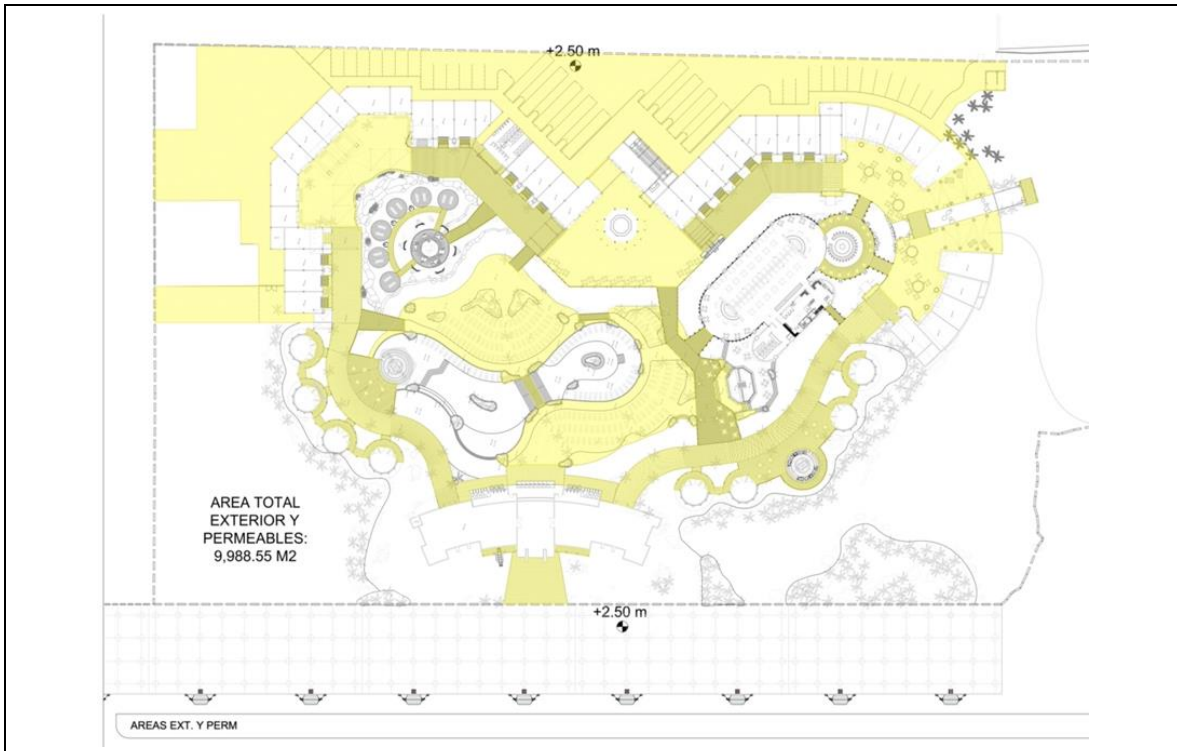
Plano de la ubicación de las áreas exteriores y permeables en el diseño del proyecto.
